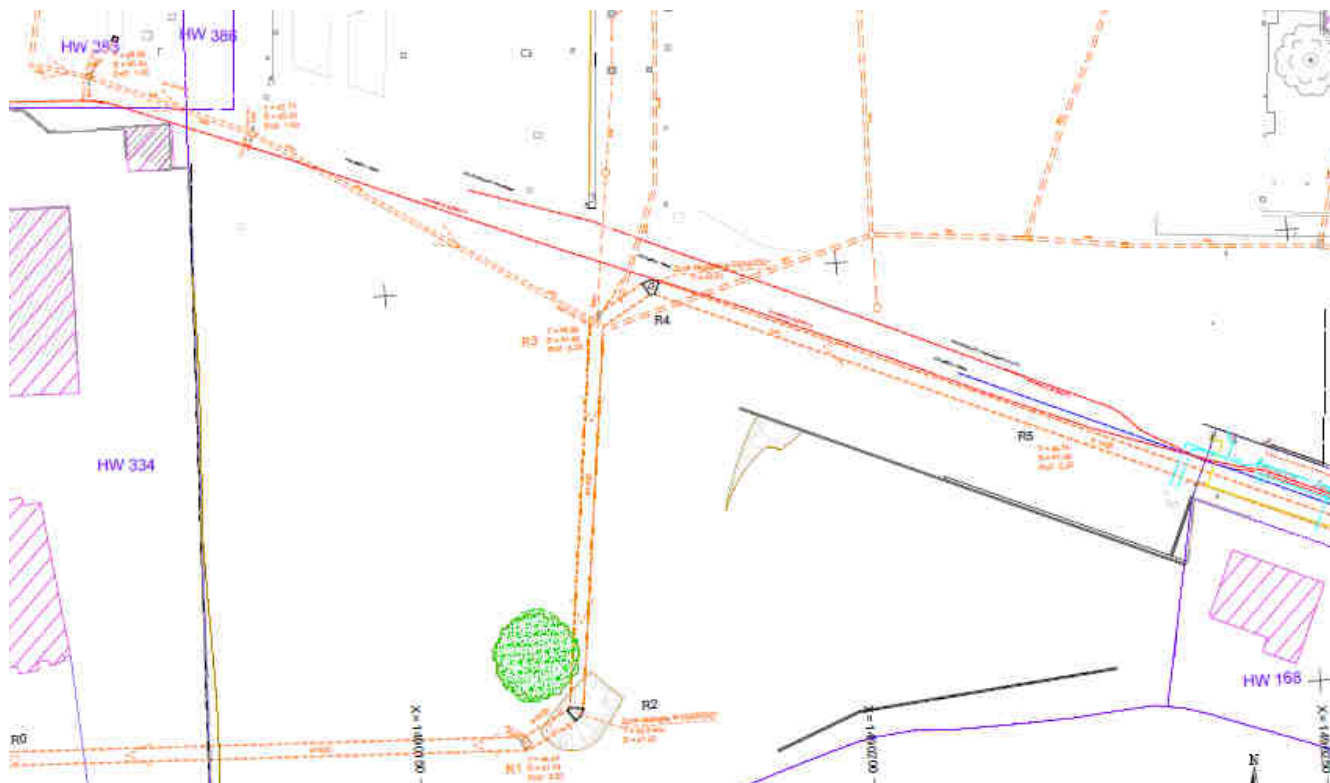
extrait du plan des réseaux existants : collecteur d'assainissement (en orange) et réseau hta sncf (en rouge)
